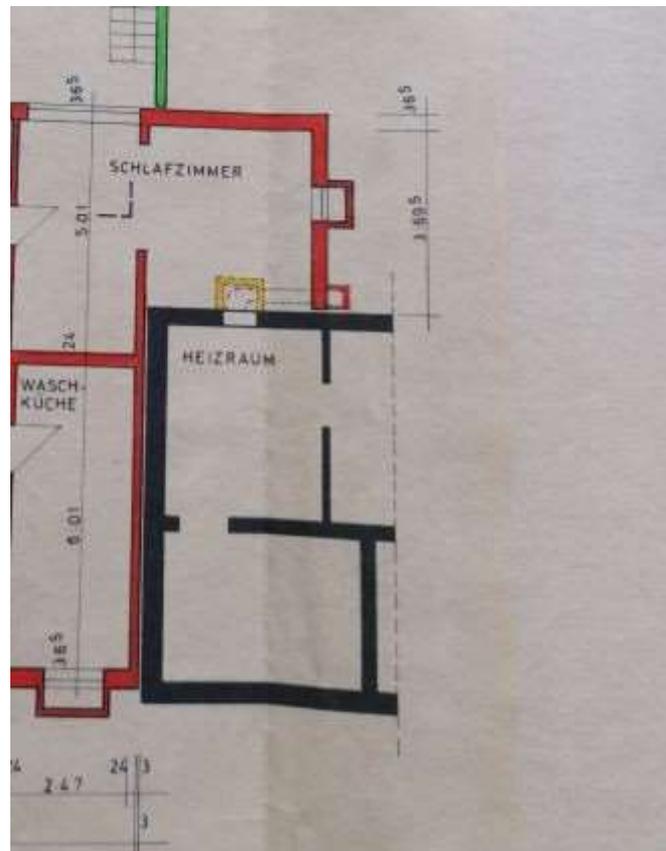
Grundriss Anbau Kellergeschoss Haus 13/11 Quelle: Unterlagen Antragsgegner
